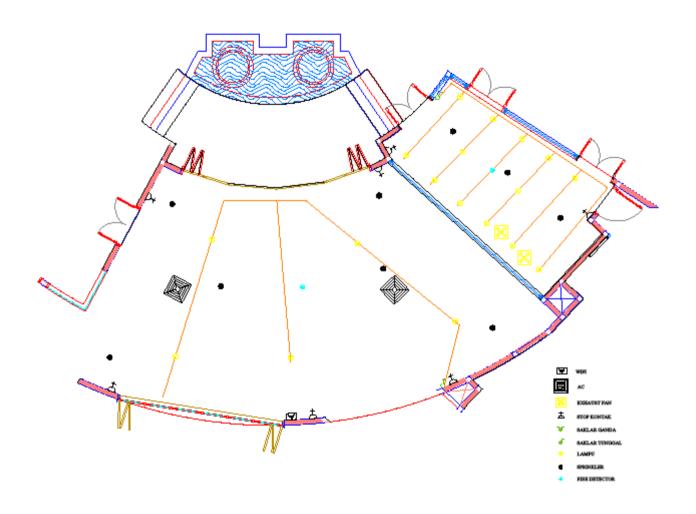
Denah Ruang Terpilih 1 (Area Makan Indoor)
